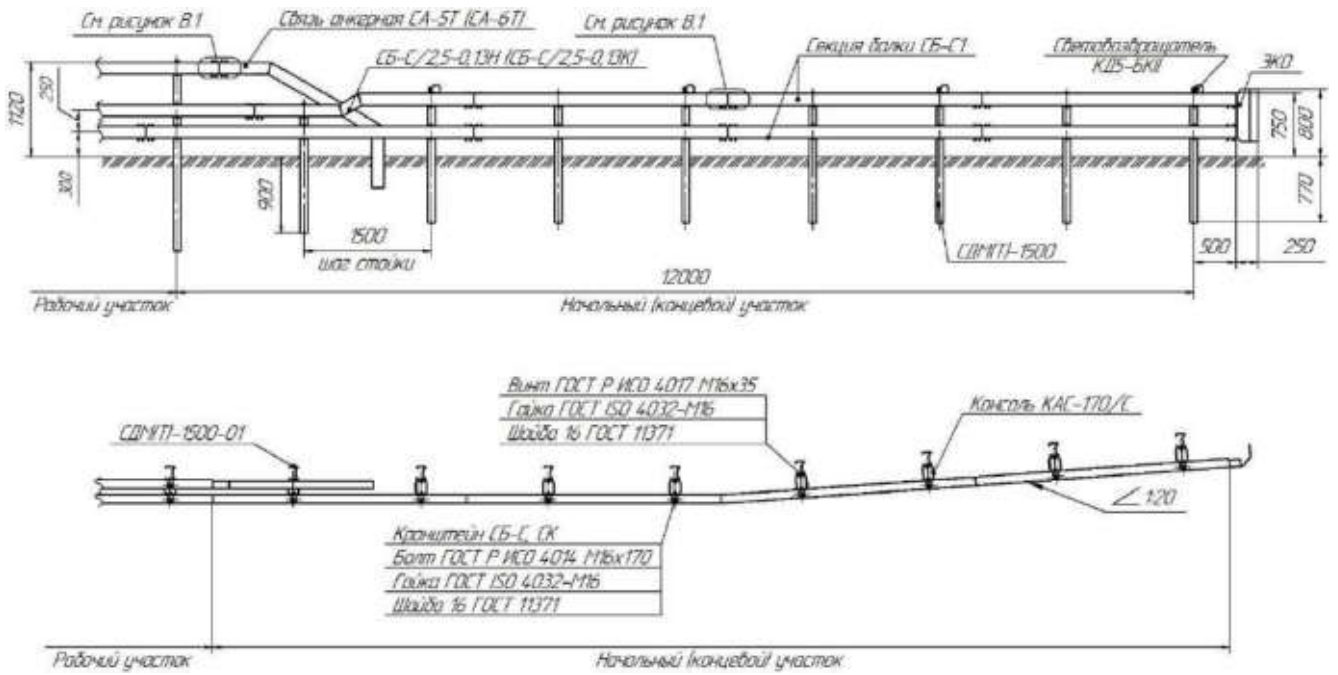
Схема сборки конструкции №13 (Изм. №1)
